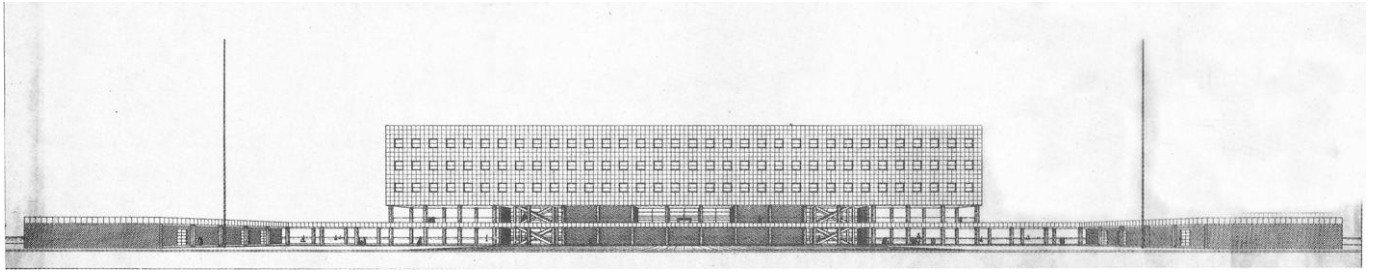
primo progetto per la colonia AGIP, vista prospettica lato strada, 1937, Archivio Vaccaro
